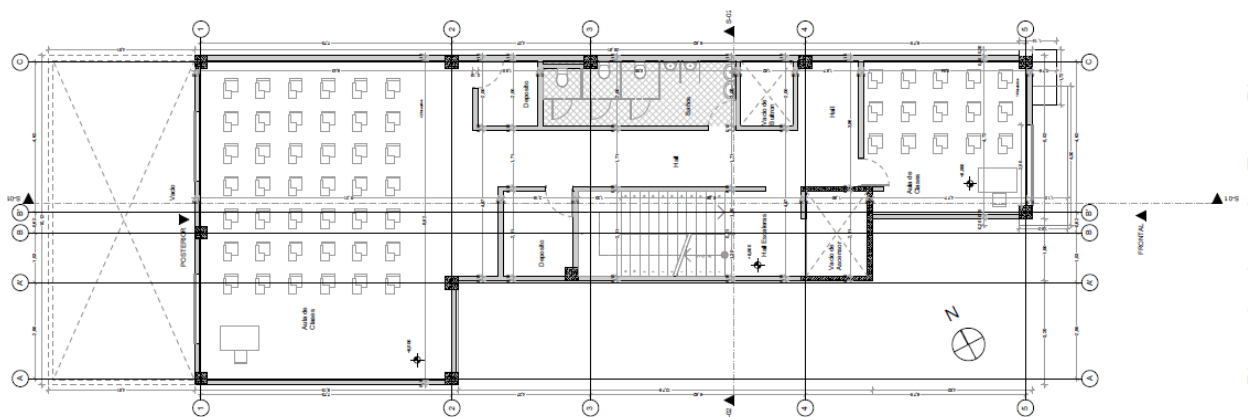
Planta Arquitectónica 3 Primer Piso Actual Cafaba.
